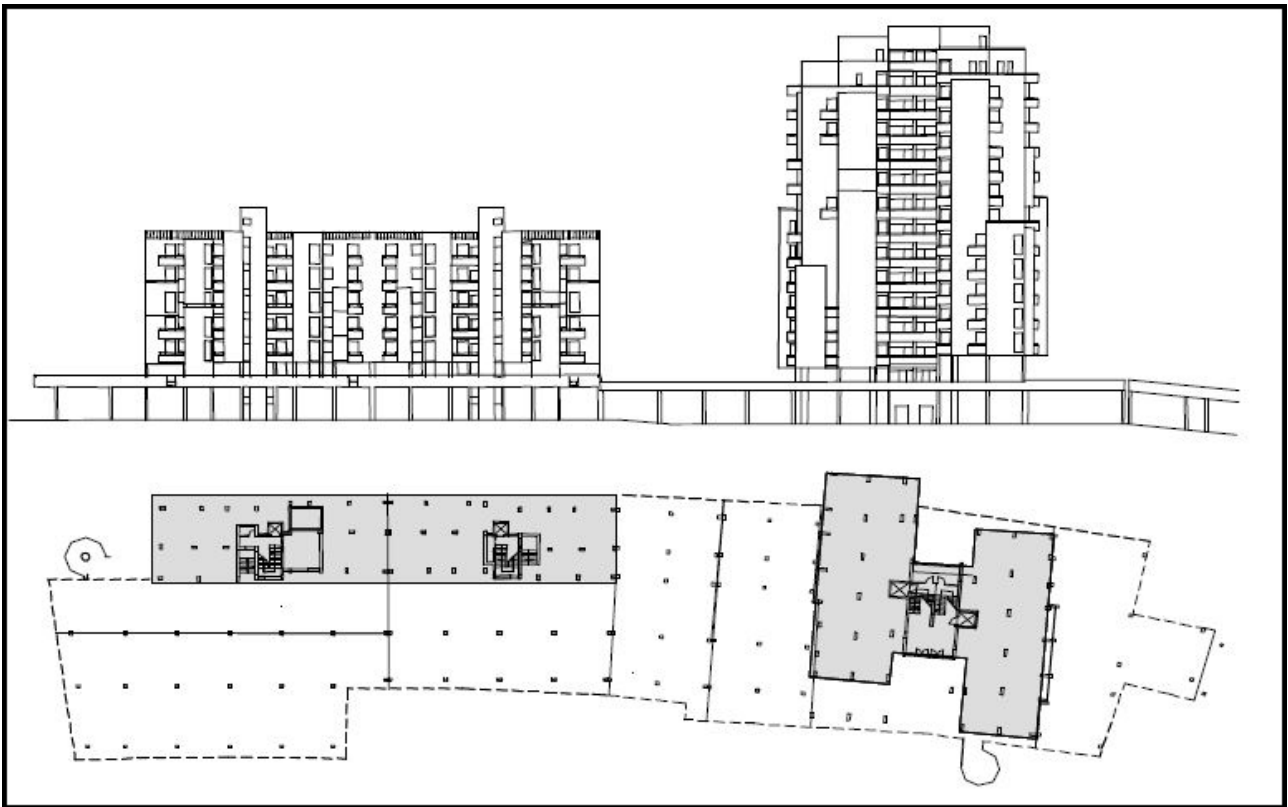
Planimetria generale e prospetto frontale del complesso di Modica
